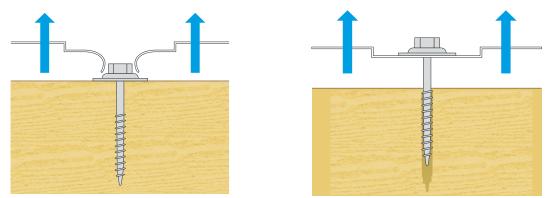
Arrachement de la tôle au niveau d'une fixation Figure 114 : Arrachement ou rupture d'une fixation Une limite de déformation de la tôle est fixée au 1/100^e de sa portée afin de limiter les désordres liés à l'étanchéité de la toiture.
